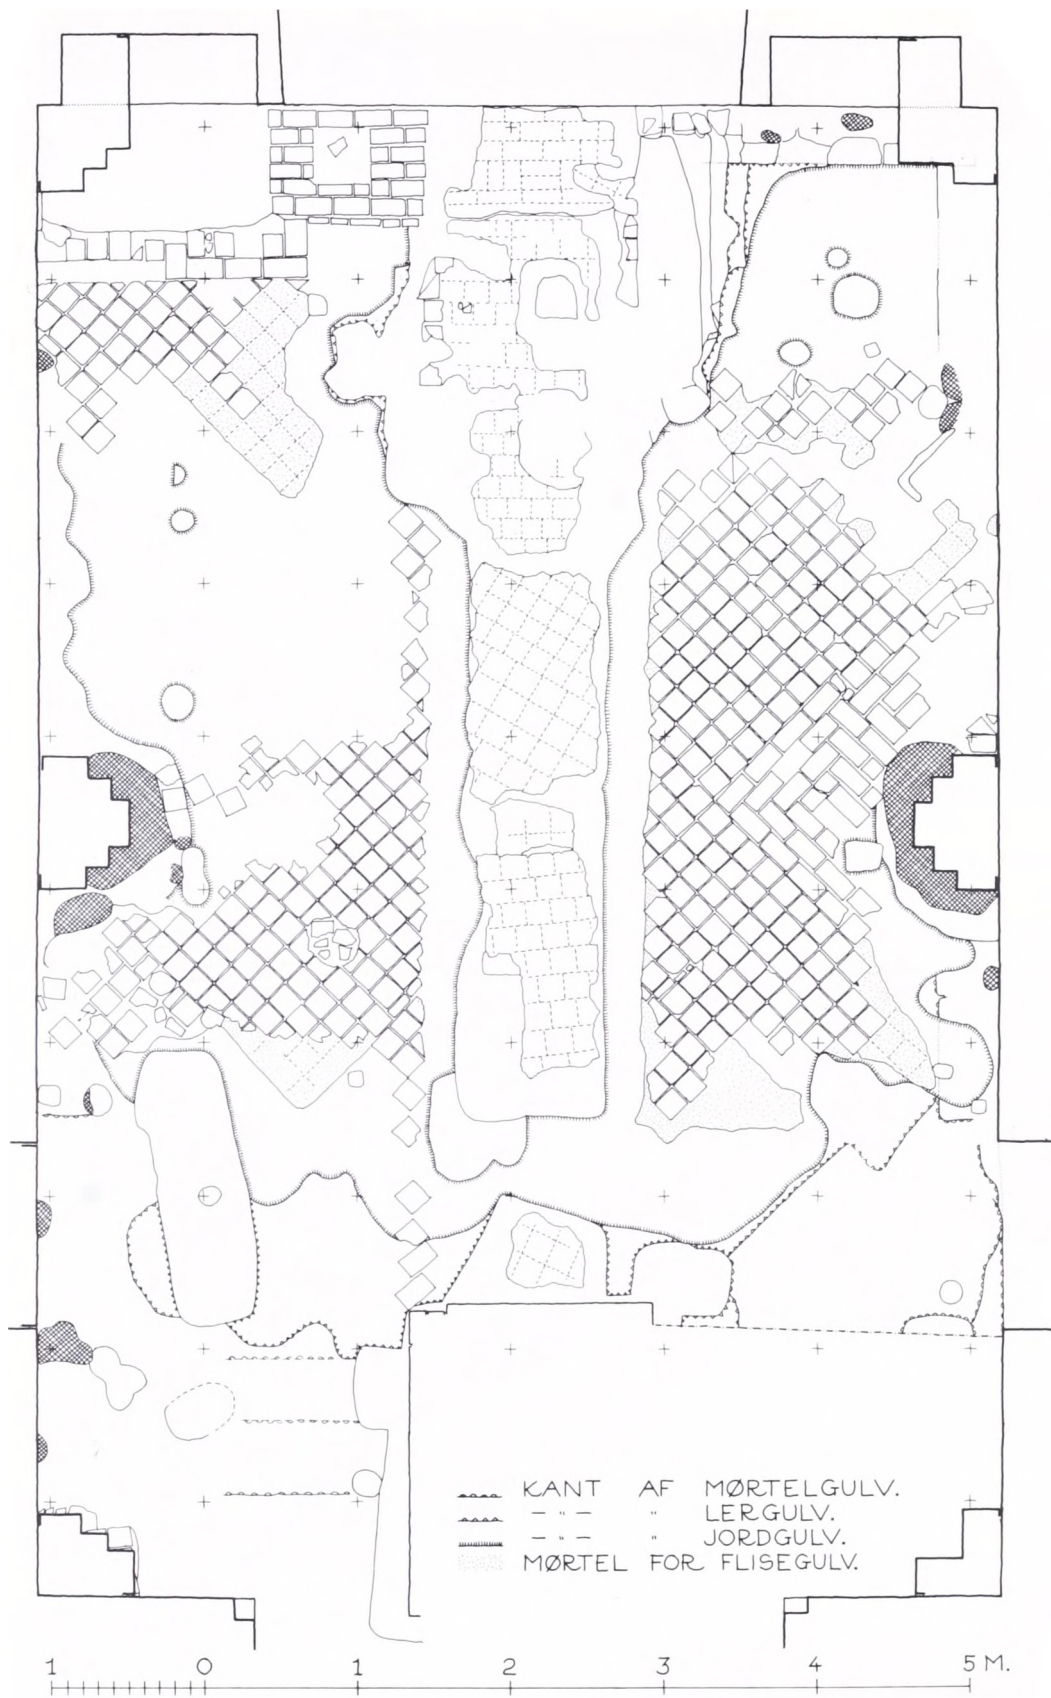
Plan 1:100 af gulvlagene i skibet, øst opad.
